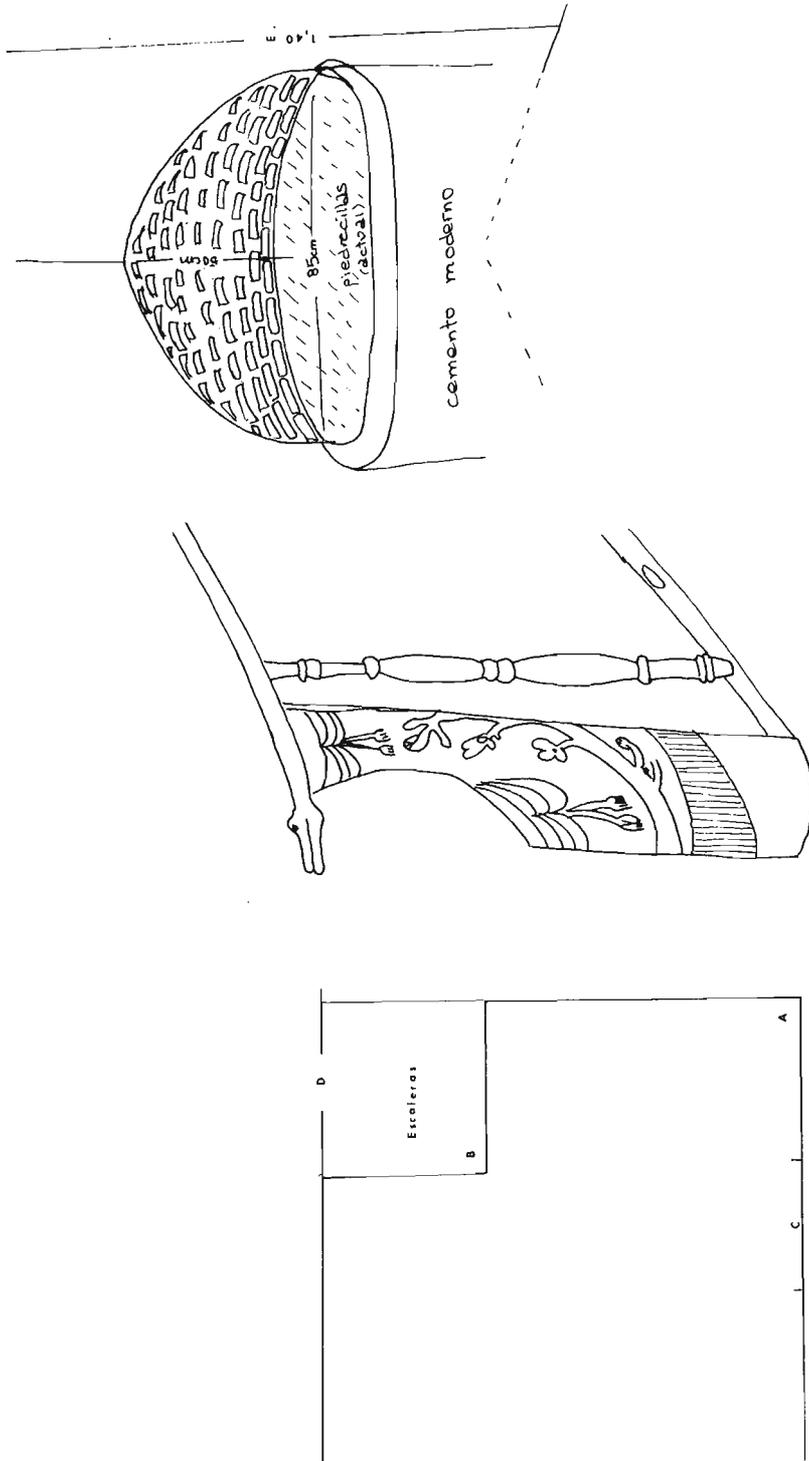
“Casa Aldaz”. Izquierda. Planta de la entrada, a) lugar donde se situaba el horno; b) lugar en el que se halla el barandado; c) portalón de acceso; d) segunda puerta, pequeña, que separa la entrada de las escaleras que llevan a las tres plantas superiores. Centro. Detalle del barandado. Derecha. Restos del antiguo horno.
